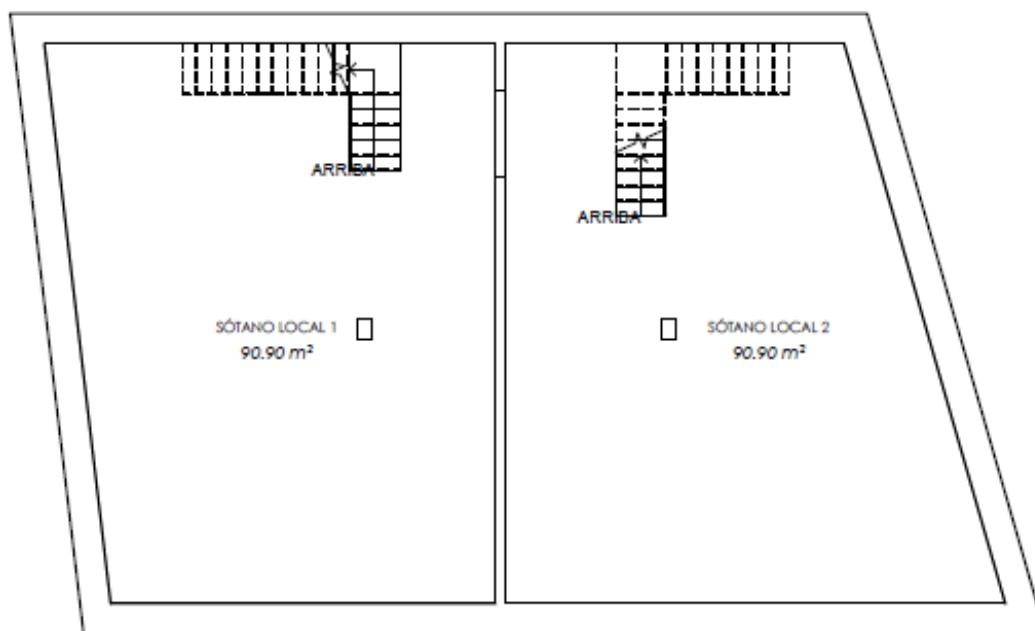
Planta Sótano. Fuente Propia (2019)
